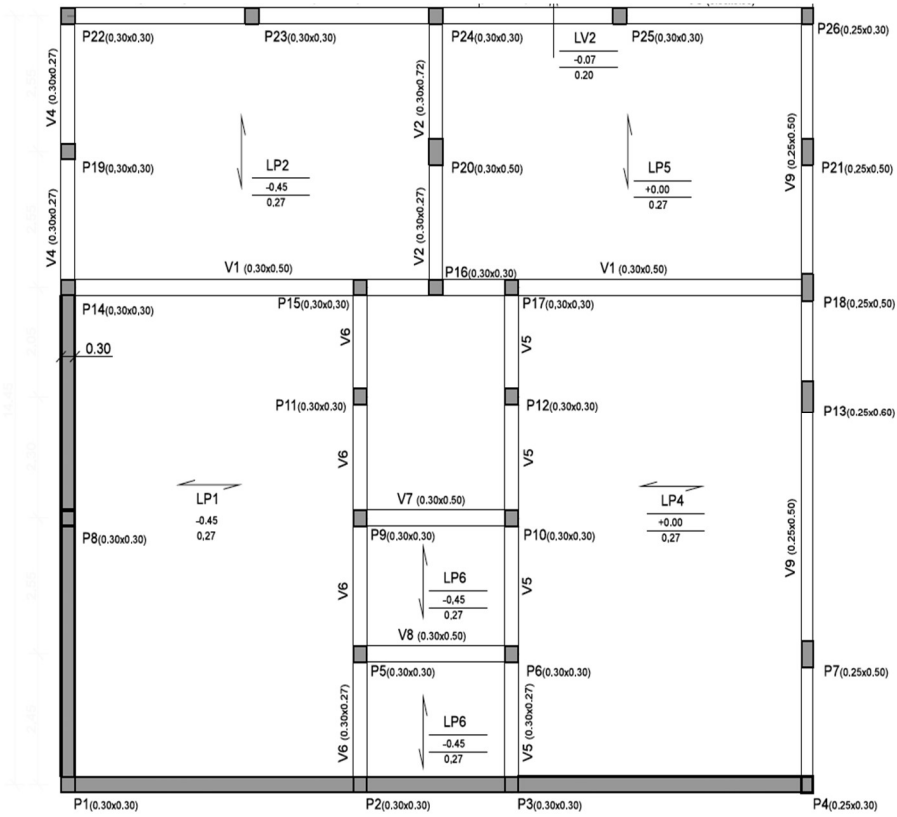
Planta Estrutural Bloco 1-0 (Semelhante ao Bloco 5).
